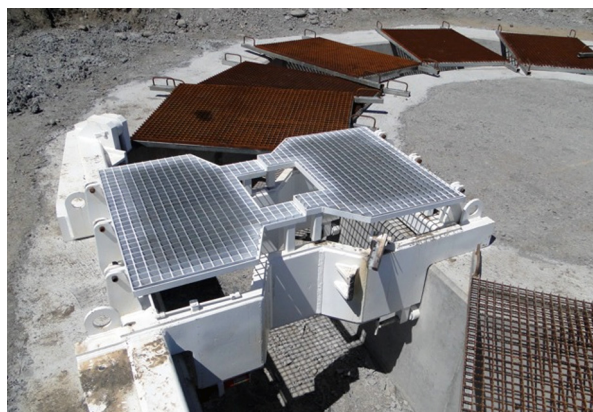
Murettes guides en béton et photo 11 guide métallique du coffrage intérieur des barrettes primaires
